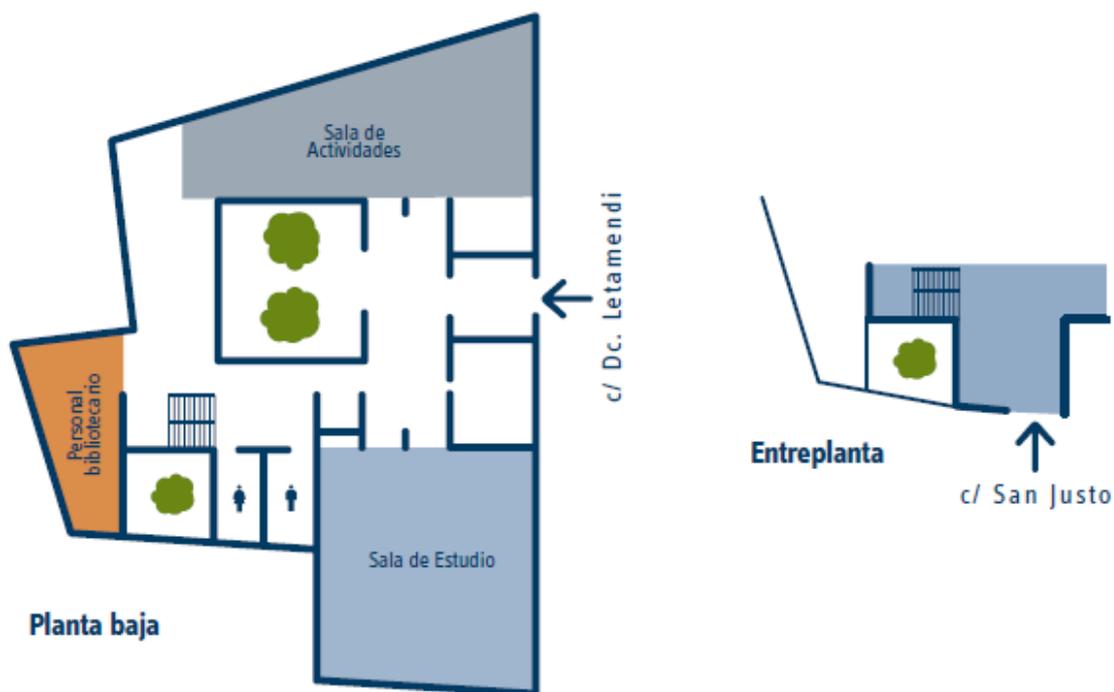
Planta baja y entreplanta de la biblioteca Iván de Vargas. Fuente: Bibliotecas Públicas Municipales
